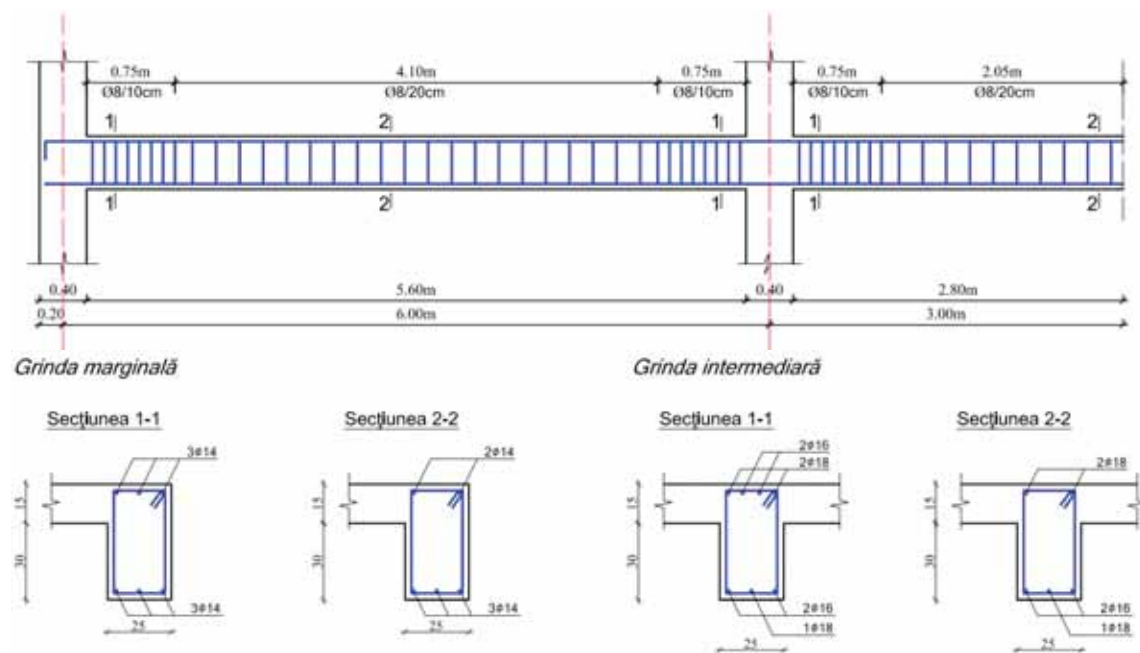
Structură P+2E: plan armare grindă longitudinală/transversală b.a
